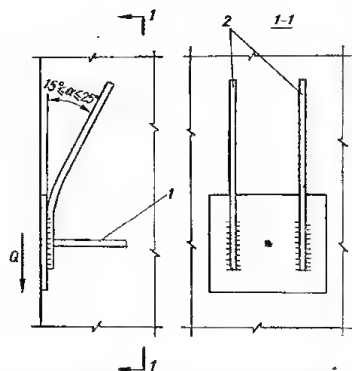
Конструкция закладной детали с анкерными стержнями, часть которых приварена к пластинкам внахлестку:
